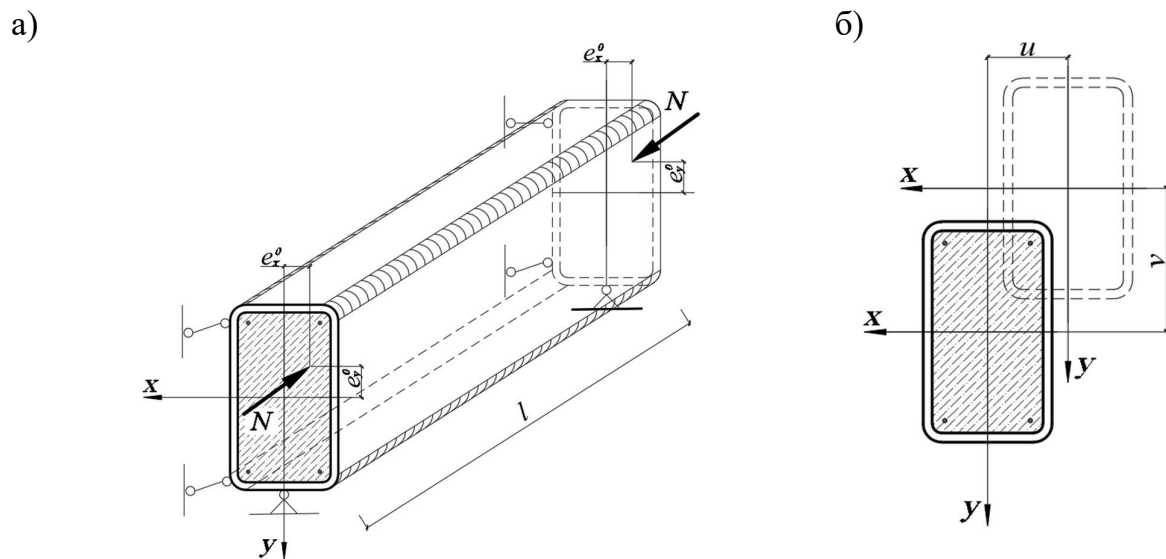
Расчетная модель стержневого элемента: а – схема нагружения; б – схема деформирования
